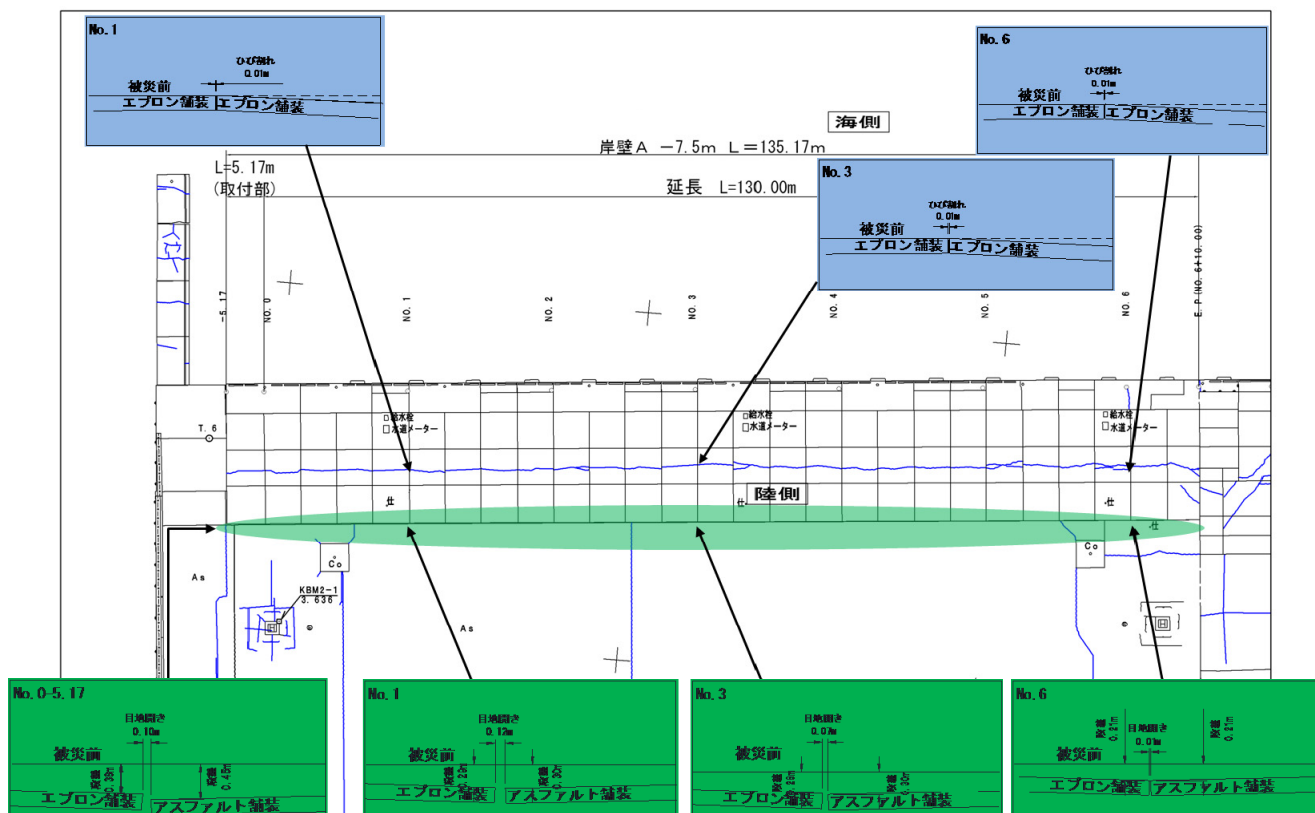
No.20 常陸那珂港区\_中央ふ頭地区岸壁（-7.5m）の平面図（被災後）
